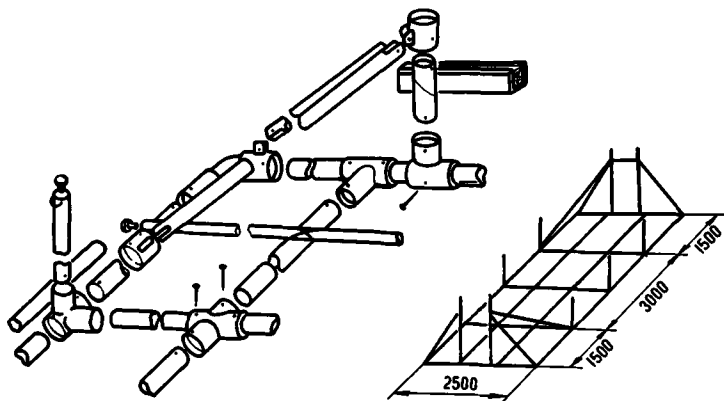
Металлический каркас из труб с муфтовыми соединениями
